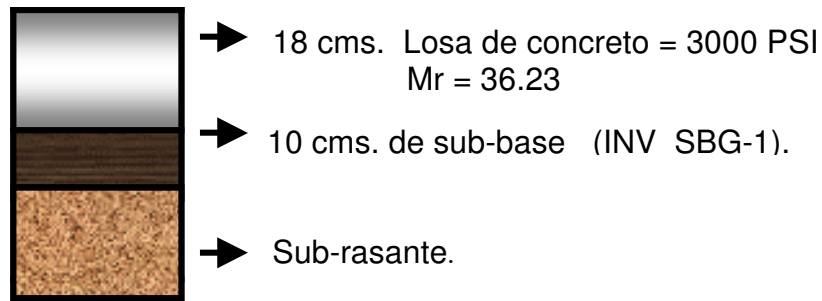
Corte transversal de la Calle 21A - Cancha Santa Mónica
